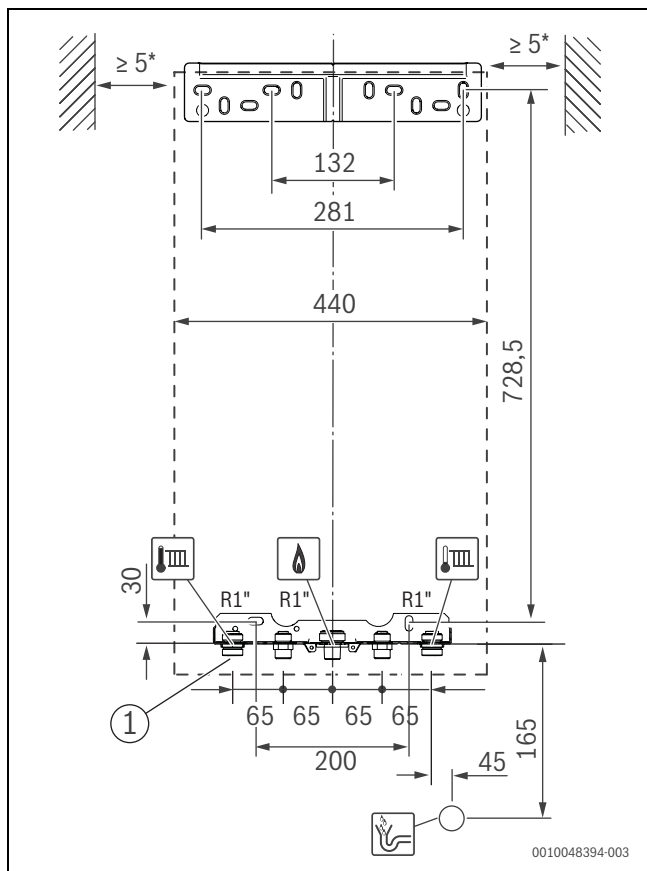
Frontansicht (mm) für GB182i.2-45 WH
